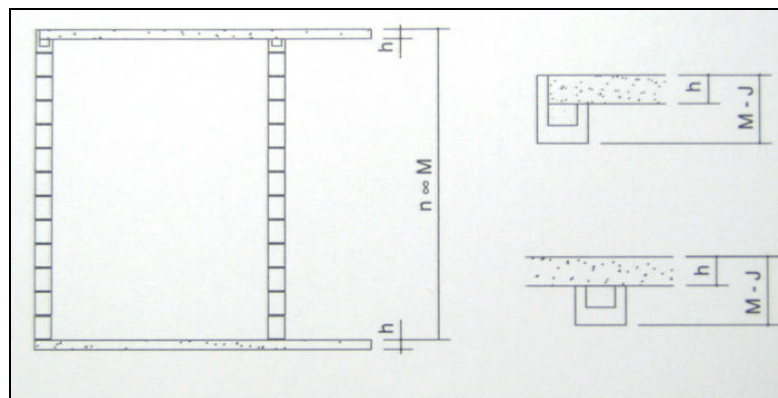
encontro de paredes com a laje na modulação de piso a piso (RAMALHO; CORRÊA, 2009, p. 23)
